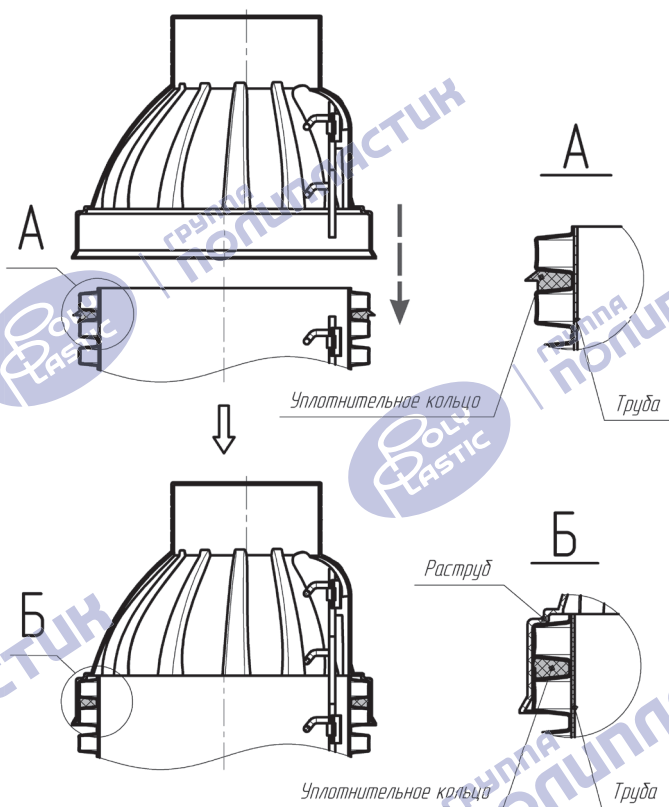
Пример установки уплотнительного кольца при соединении конуса и шахты колодца
